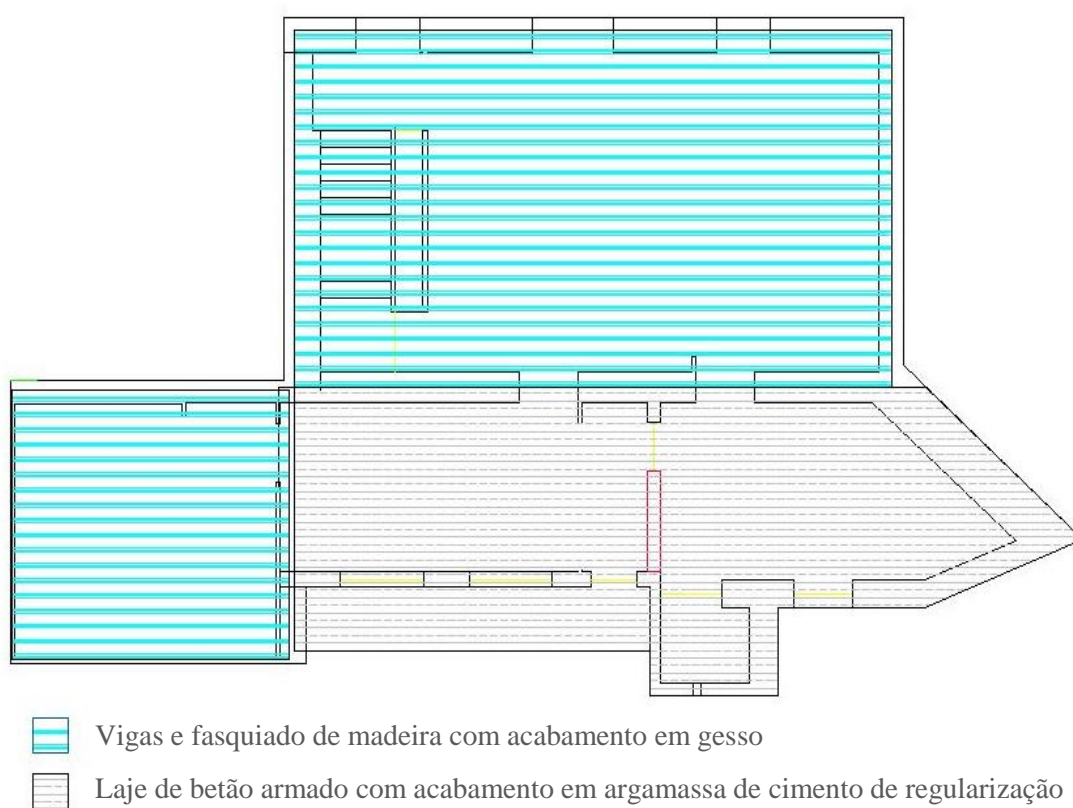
Planta de caracterização das lajes de teto do 1º andar
